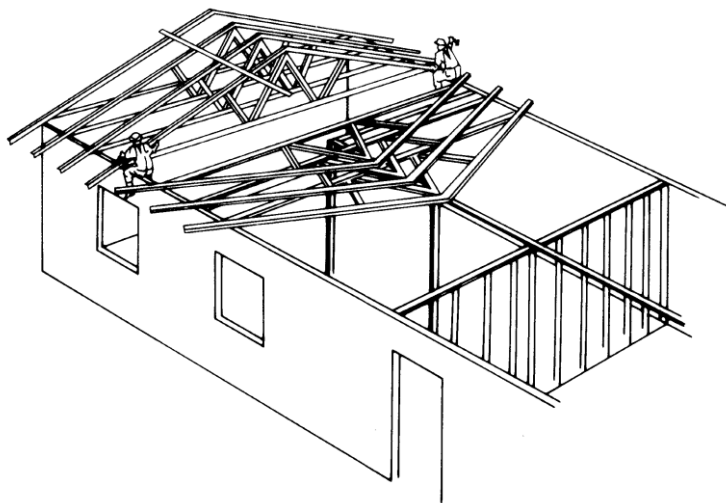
Фермы крыши устанавливаются на стены, поднимаются в вертикальное положение и крепятся гвоздями и на месте
